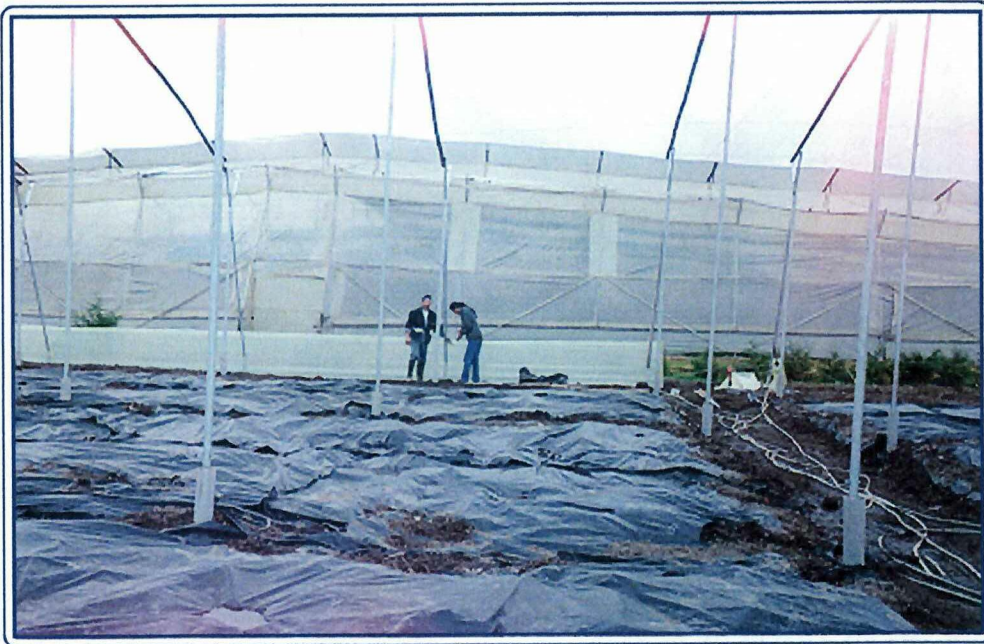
Ubicación de tuberías en las zonas de drenaje
